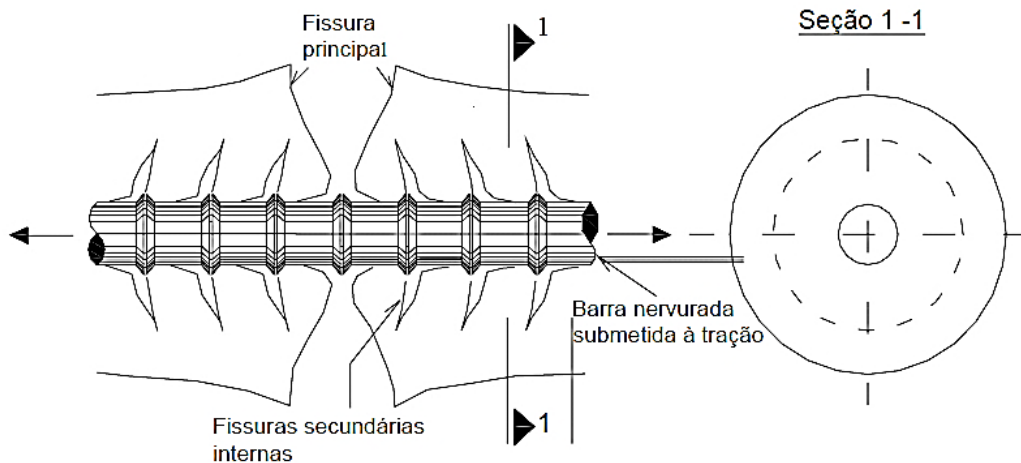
Deformação do concreto após a formação de fissuras (GOTO, 1971).
